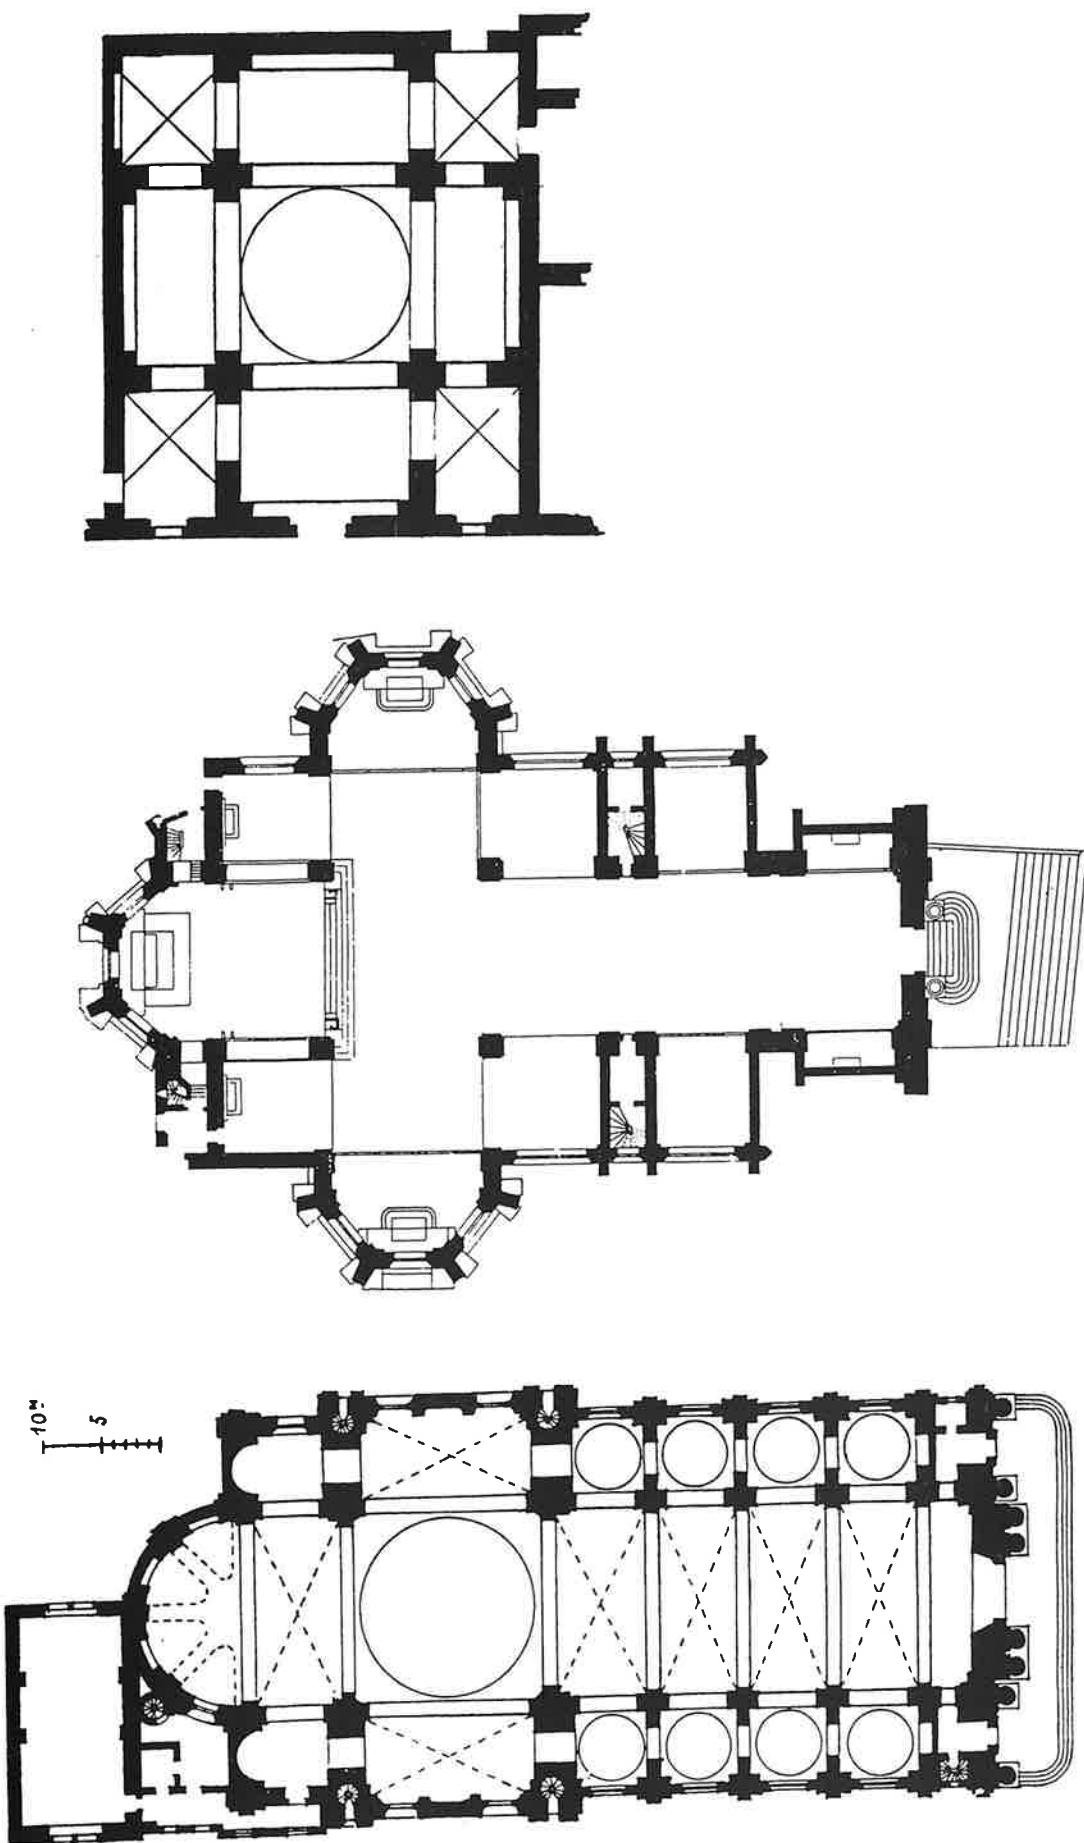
Paris, Église Saint - Paul - Saint - Louis plan — Rouen, Chapelle du collège des Jésuites (lycée), plan — Avignon, Chapelle du noviciat des Jésuites (hospice), plan intérieure
